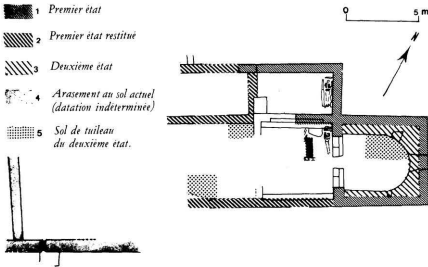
Plan : I.A.M. (Hallier, Levine) et R. Bracker.
